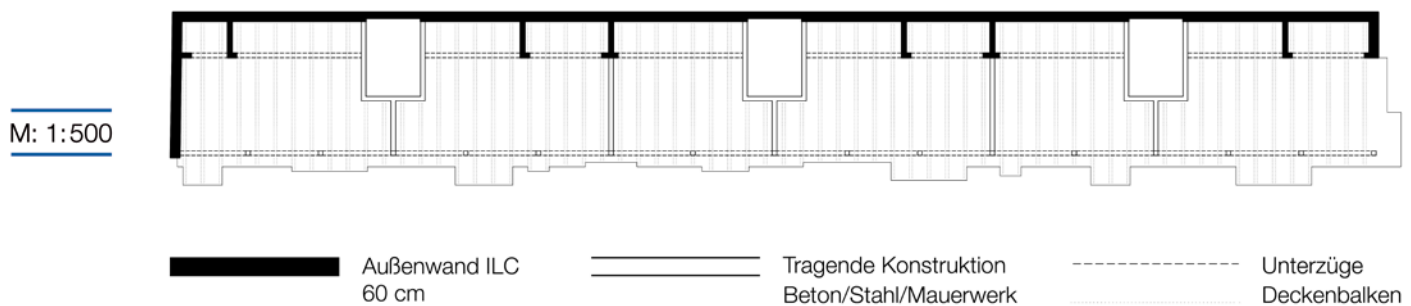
Konstruktionsprinzip Typenentwurf »Zeilenbau« in Ortbetonbauweise
